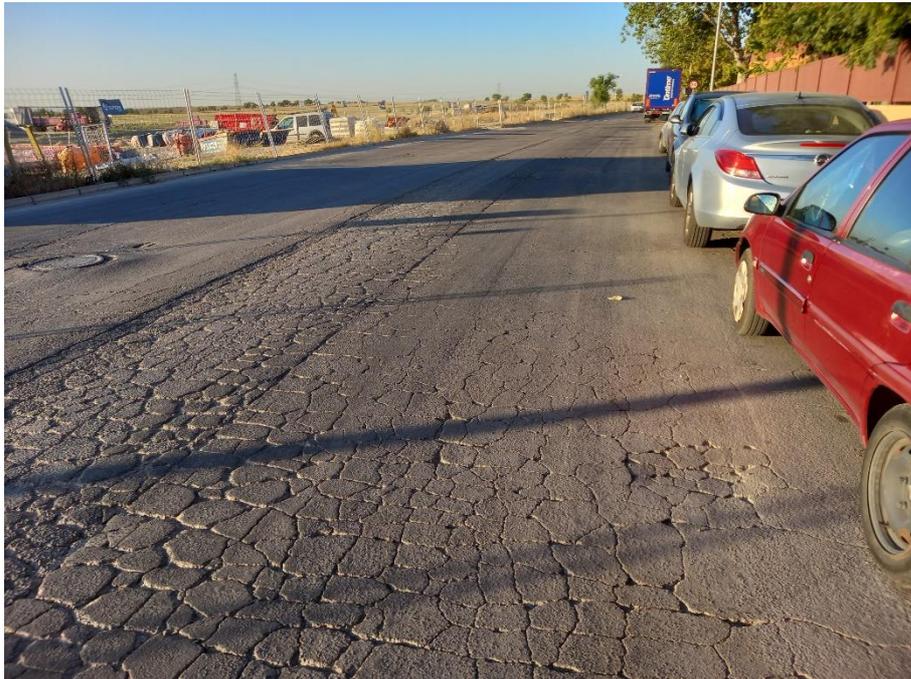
Estado del pavimento tramo calle Ángeles-calle Cañadas del Teide.
